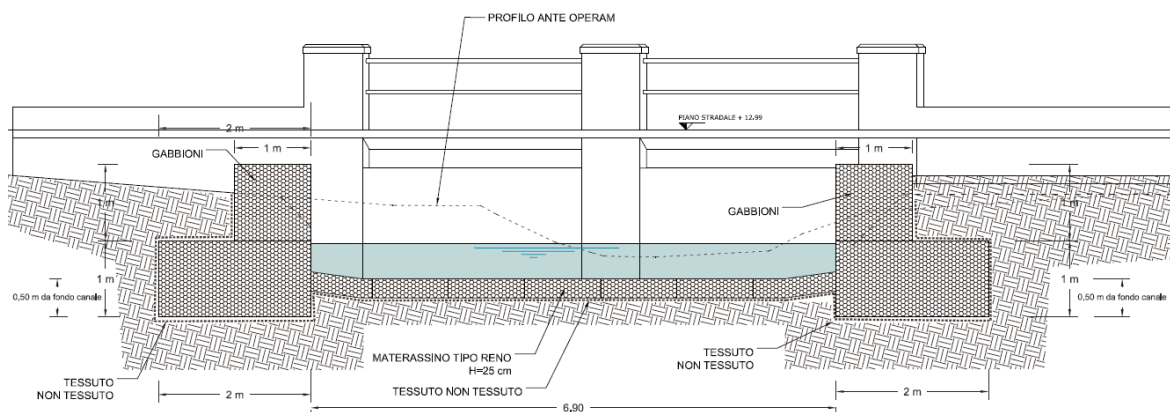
Vista frontale del ponte all'intersezione con la SP 123
